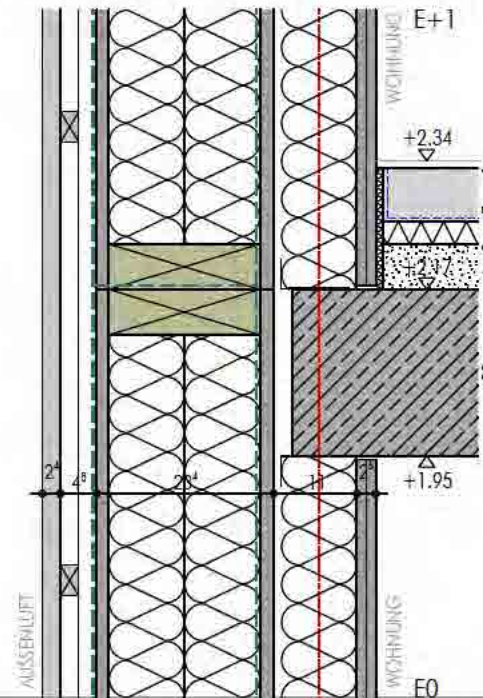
DETAIL KOPF- UND FUSSPLATTE DECKE ÜBER E0 UND E+1
